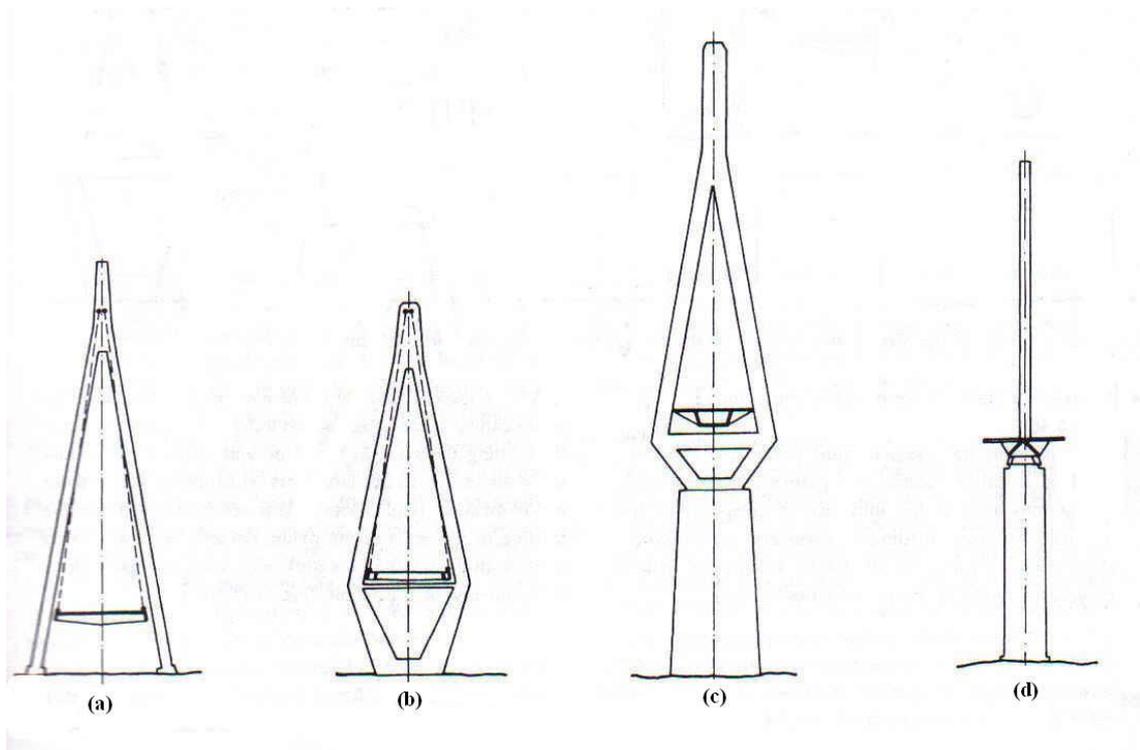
Influencia del nivel del tablero en la parte baja del pilón.
